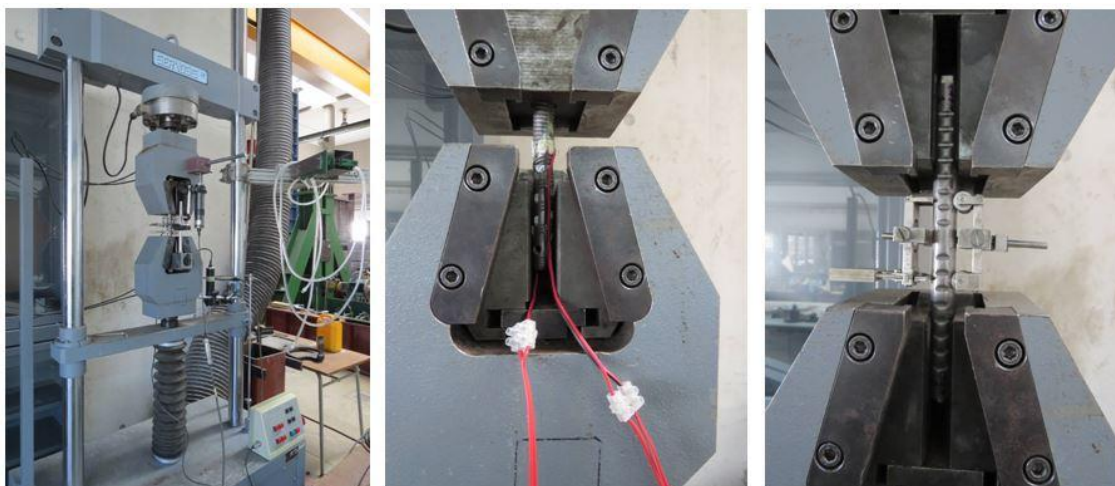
Setup de ensaio de tracção: a) plano geral, b) pormenor da amarração dos conectores HILTI HCC-B, c) pormenor da amarração dos restantes conectores
